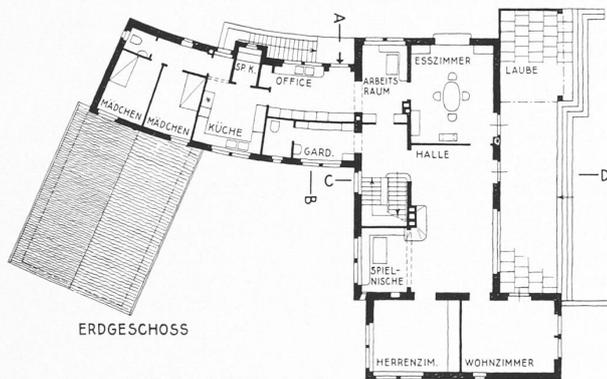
Grundrisse 1 : 400 des Hauses S.-v.-H. in Küsnacht. — Architekten MOSER & KOPP, Zürich
